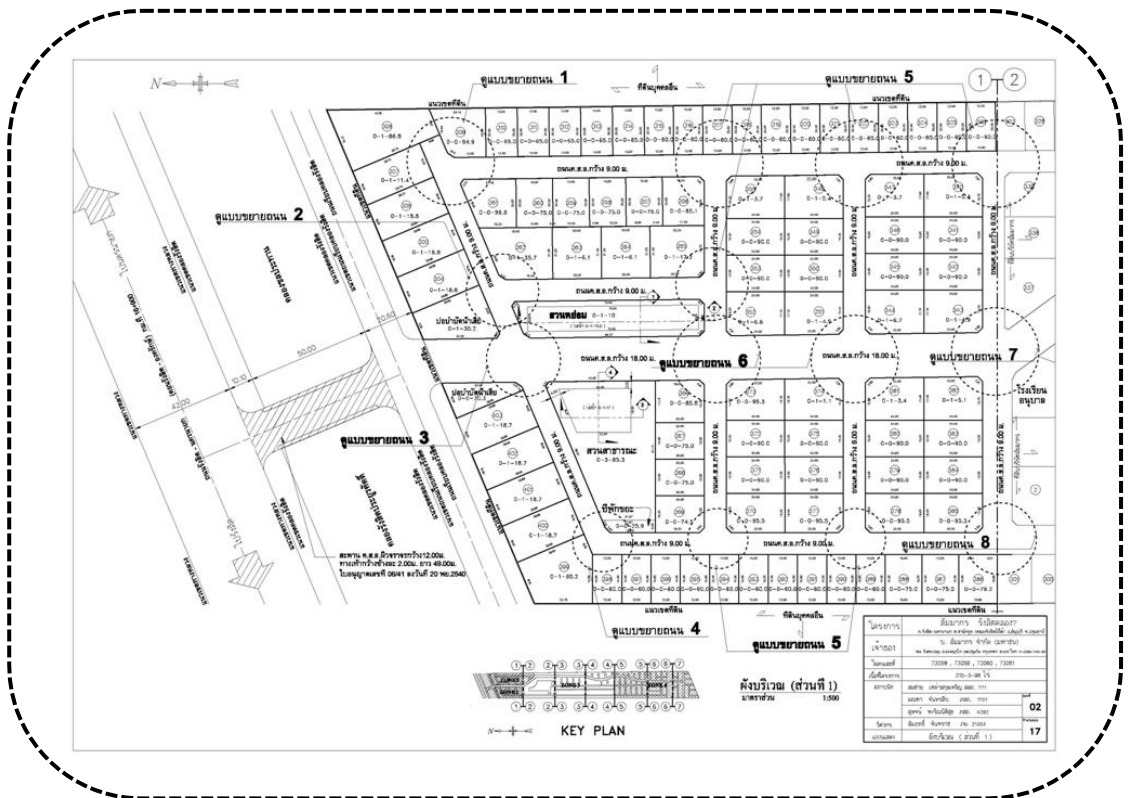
แสดงผัง Marterplan โครงการหมู่บ้านสัมมากร รังสิต คลอง 7 (หลังปรับผัง)
